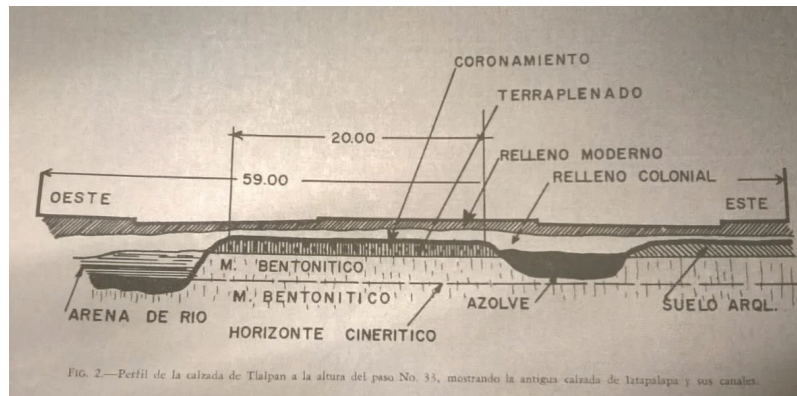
Coupe de la chaussée d'Iztapalapa (source : González Rúl, 1961: 117)
